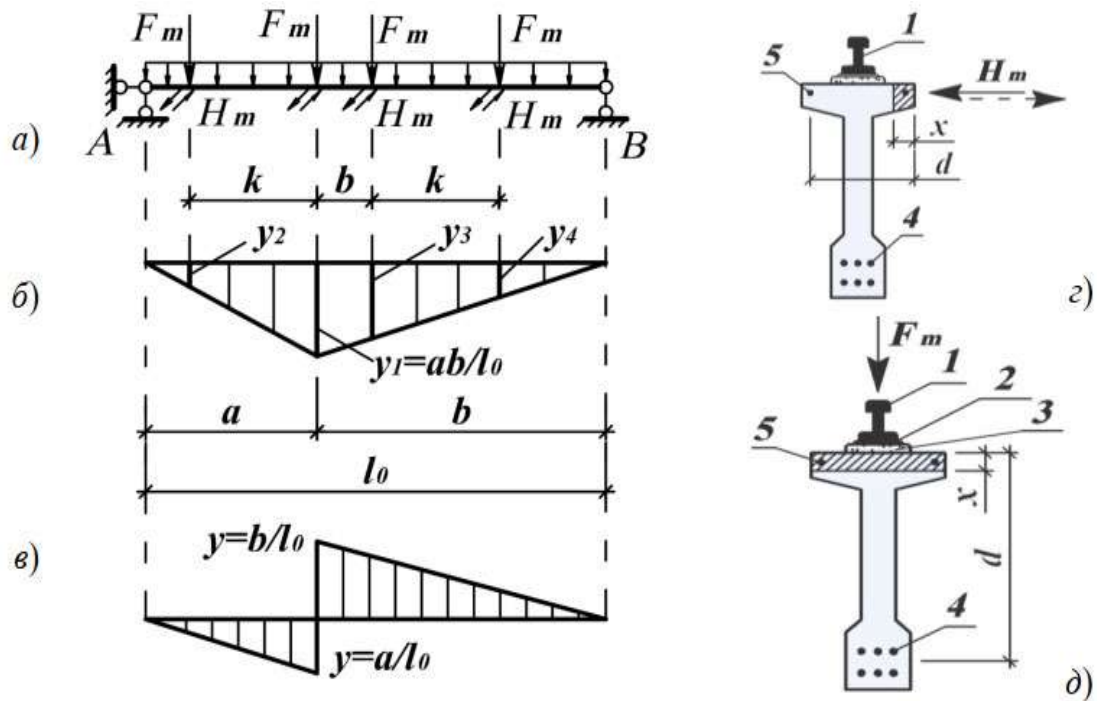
Схеми до розрахунку підкранових блоків:  $a$  – схема завантаження;  $б$  – ліній впливу  $M$ ;  $в$  – ліній впливу  $V$ ;  $г$  – розрахункова схема поперечного перерізу на дію горизонтальних навантажень;  $д$  – розрахункова схема поперечного перерізу на дію вертикальних навантажень; 1 – підкранова рейка; 2 – пружна прокладка; 3 – вирівнювальний шар розчину; 4 – поперечно напружена арматура у нижній зоні балки; 5 – поперечно напружена арматура у верхній зоні балки
